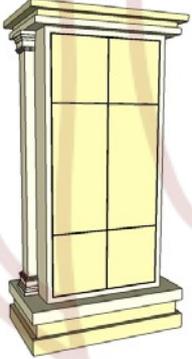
Keputusan akhir ceiling *runaway hall
